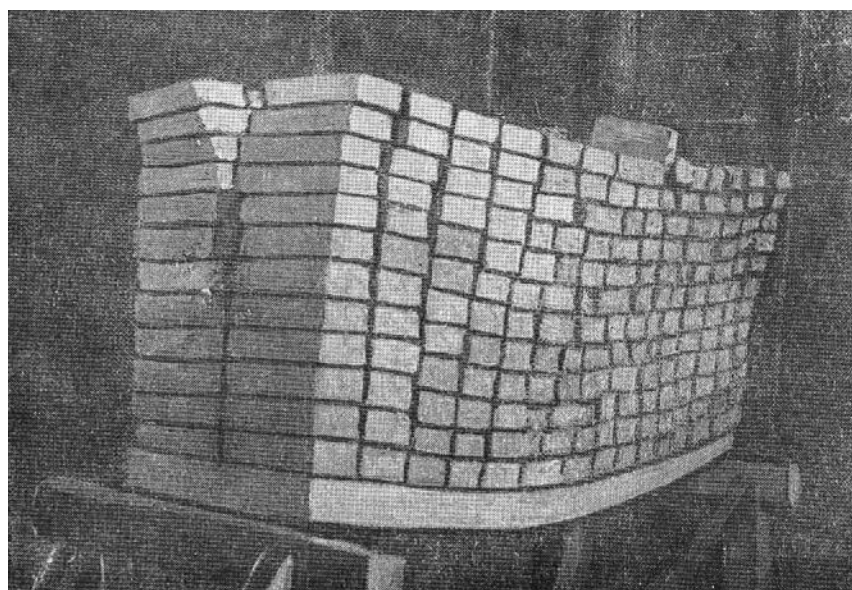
Испытание гипсовой плиты перекрытия (1961 г., нагрузка соответствует весу 336 кирпичей)
